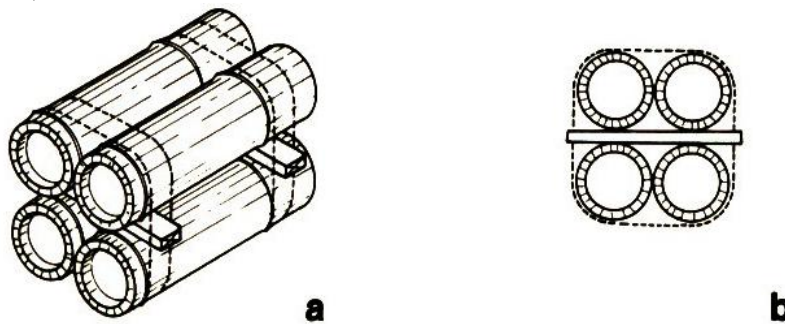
Vigas formadas por 4 ou 6 elementos.
